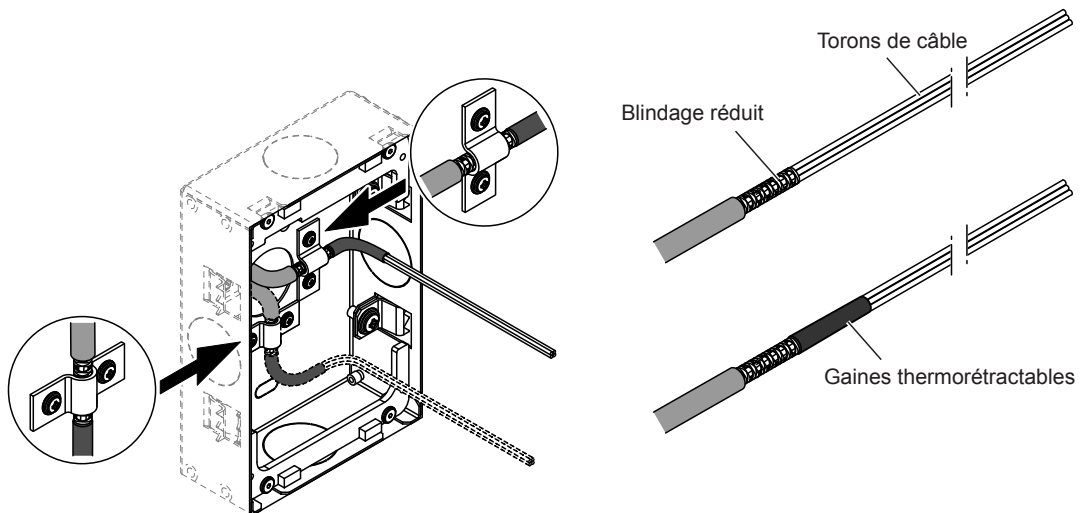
Fixez le câble CAN BUS avec le blindage exposé au boîtier à l'aide des colliers de serrage
